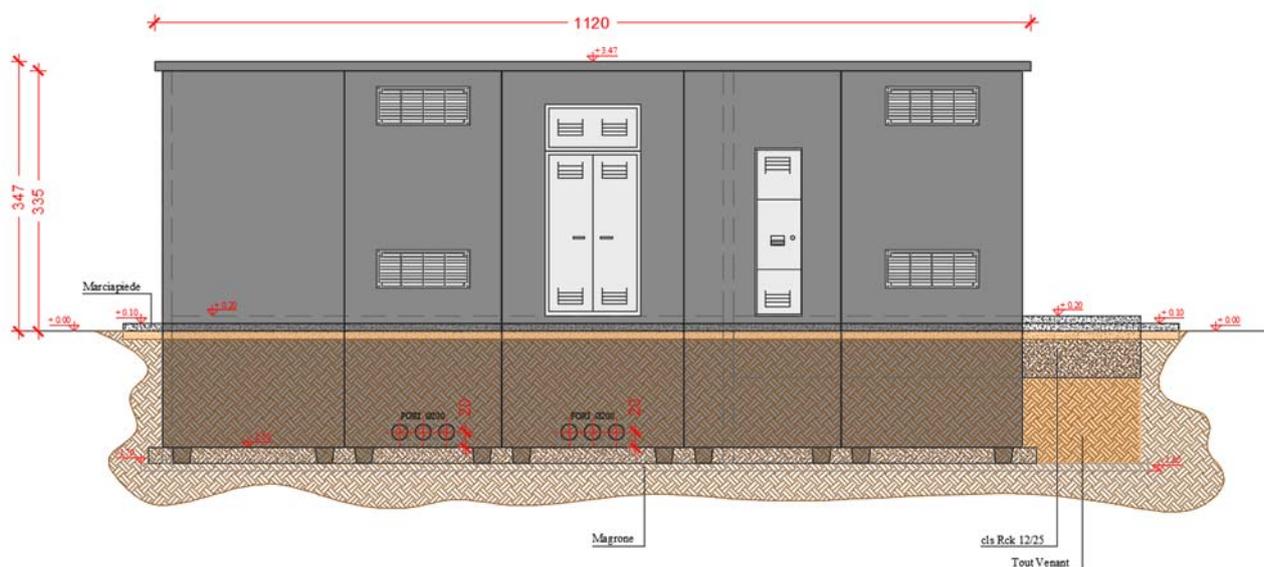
Tipico Prospetto principale della cabina Slave-Master
